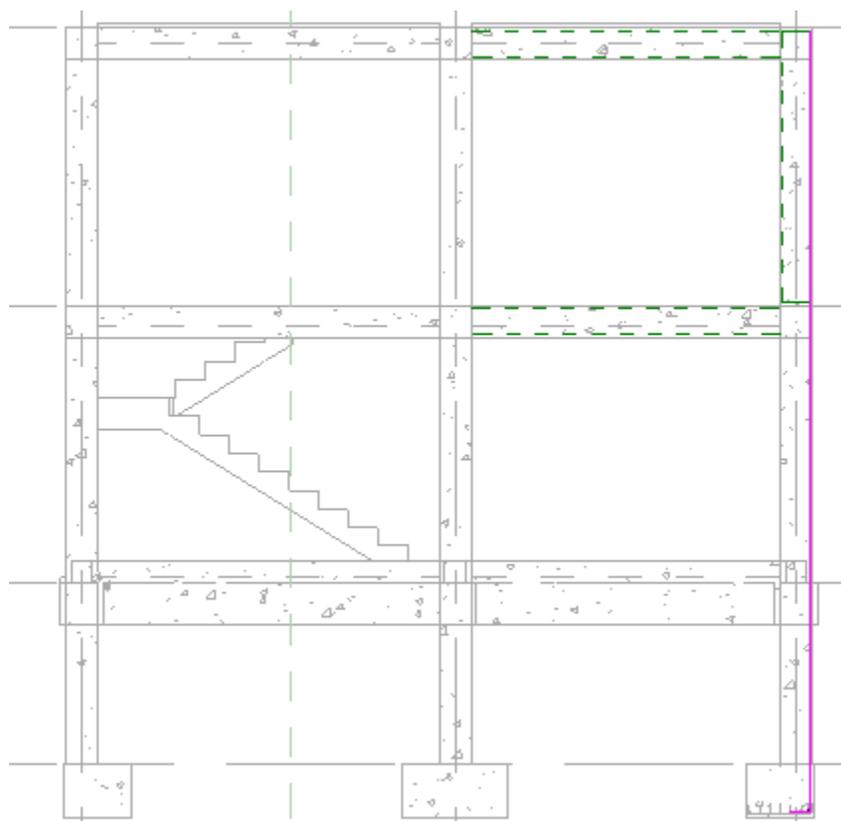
Acero de refuerzo en la columna con método por boceto.
